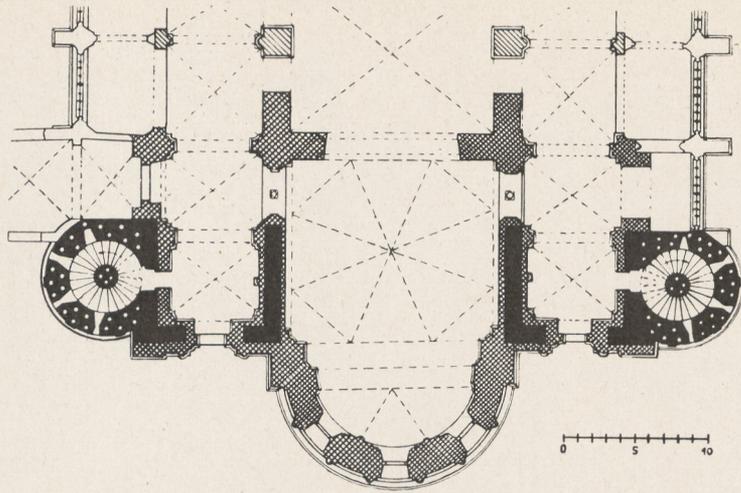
und 8. Westbaugrundrisse des Mainzer Doms (nach Weigert)
